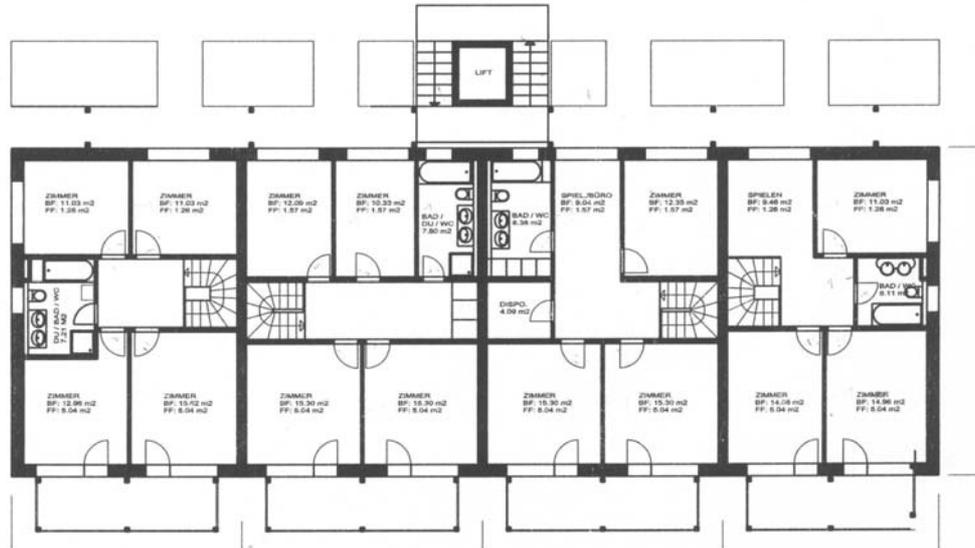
Grundriss 1. Obergeschoss Haus „im Wechsel“
